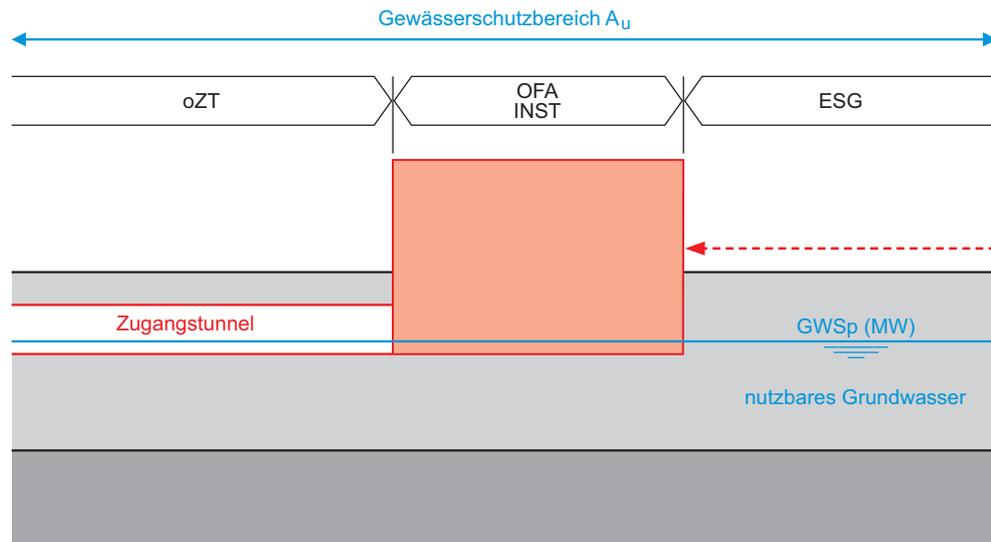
Grundwassersituation Typ C – Bauwerk im Gewässerschutzbereich A_u über dem nutzbaren Grundwasser mit kleinem Flurabstand mit permanenten Bauwerksteilen unter dem mittleren Grundwasserspiegel, ohne mehr als 10 % der Durchflusskapazität des nutzbaren Grundwassers zu beanspruchen.
